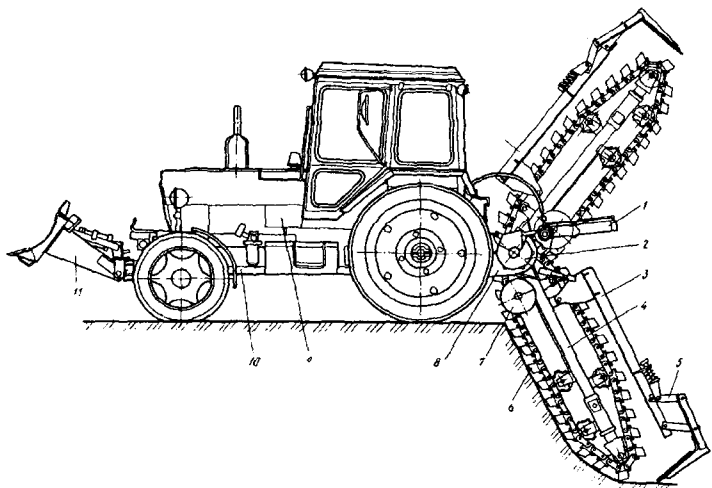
Общий вид многоковшового экскаватора на базе колесного трактора: 1 – механизм подъема и опускания рабочего органа; 2 – приводной вал; 3 – дополнительная рама рабочих органов; 4 – рабочий орган; 5 – зачистной башмак; 6 – рабочая цепь; 7 – шнек; 8 – редуктор привода рабочего органа; 9 – ходоменьшик; 10 – трактор; 11 – бульдозерный отвал.
